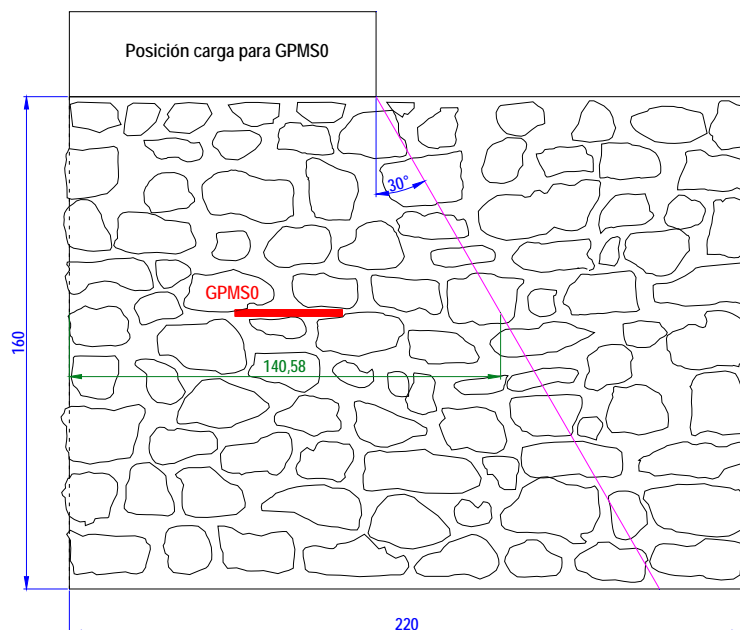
Ubicación del ensayo de gato plano simple GPMS0 en el alzado del muro de mampostería. Las cotas relacionadas están en cm.
